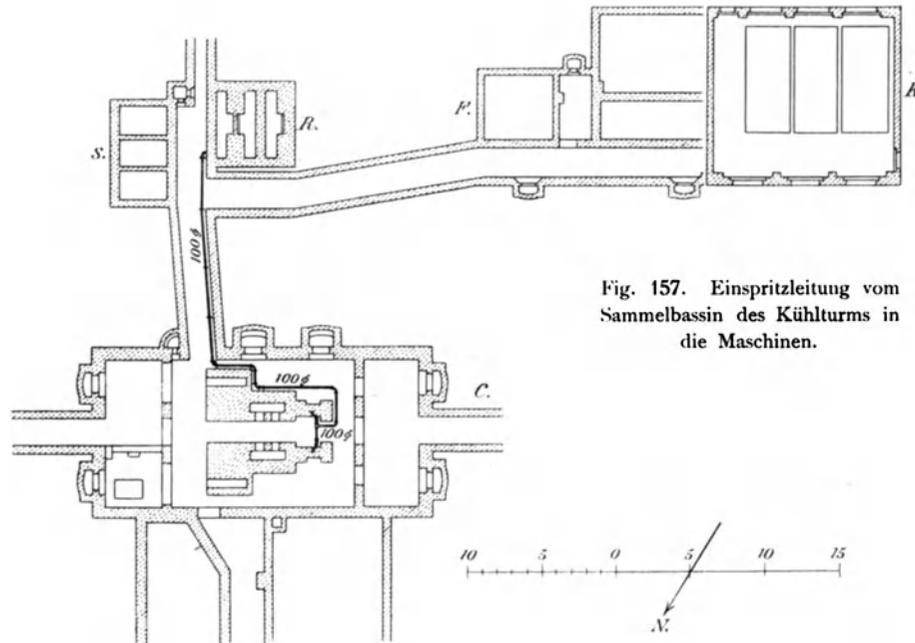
Einspritzleitung vom Sammelbassin des Kühlturms in die Maschinen.
